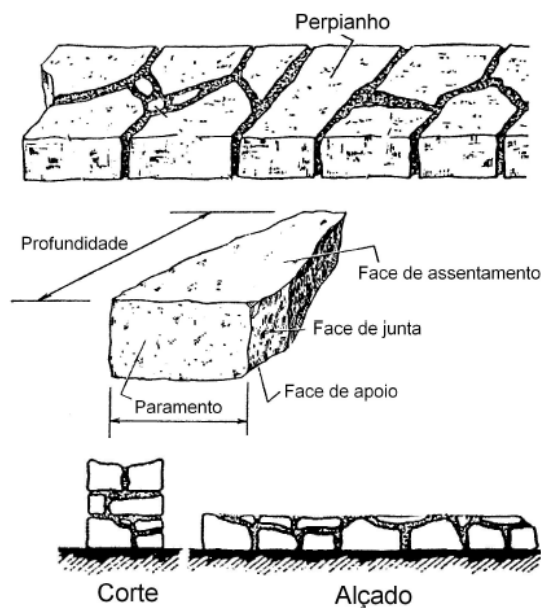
Detalhe de elevação de uma parede de pedra aparelhada (Azevedo 2010, p. 26).
